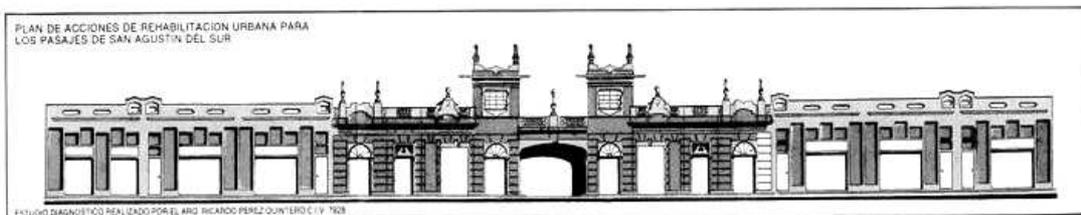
Plan de Rescate de la Urb. San Agustín del Sur, 1995.
